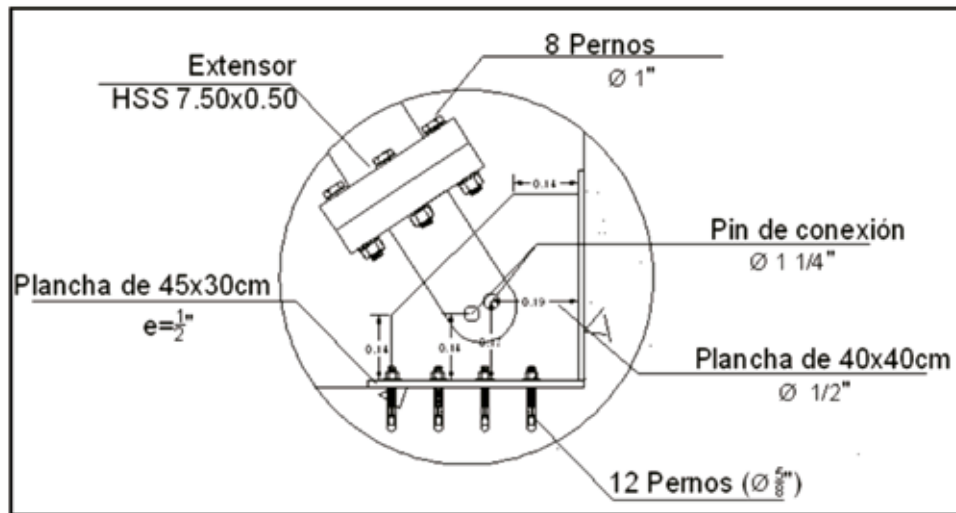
DETALLE 3 (CONEXIÓN: DISIPADOR – CARTELA – ESTRUCTURA DE CONCRETO)
